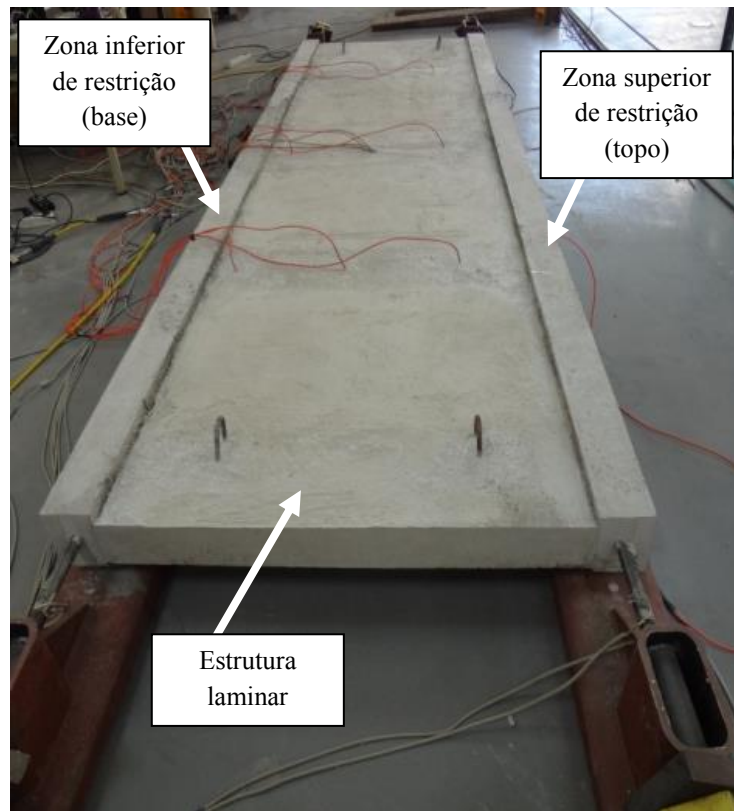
Vista geral da estrutura laminar ensaiada em laboratório.
